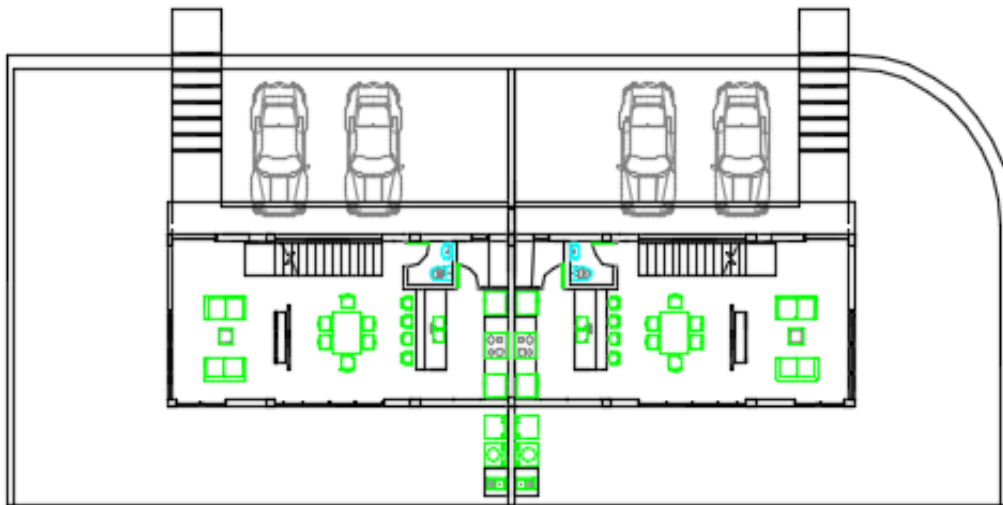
Implantación del proyecto Ukumary planta baja - Fuente: Carphio, (2017)
